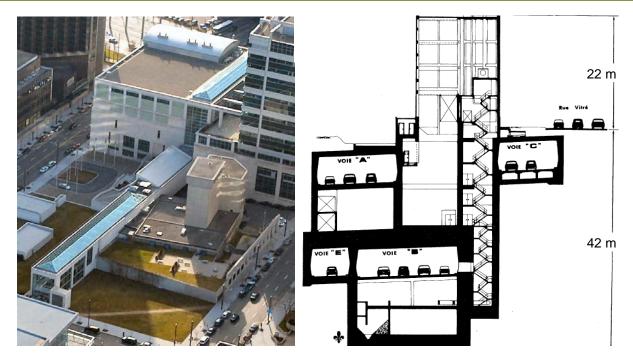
Pozo de ventilación nº. 9: Vista exterior y sección transversal de la estructura
